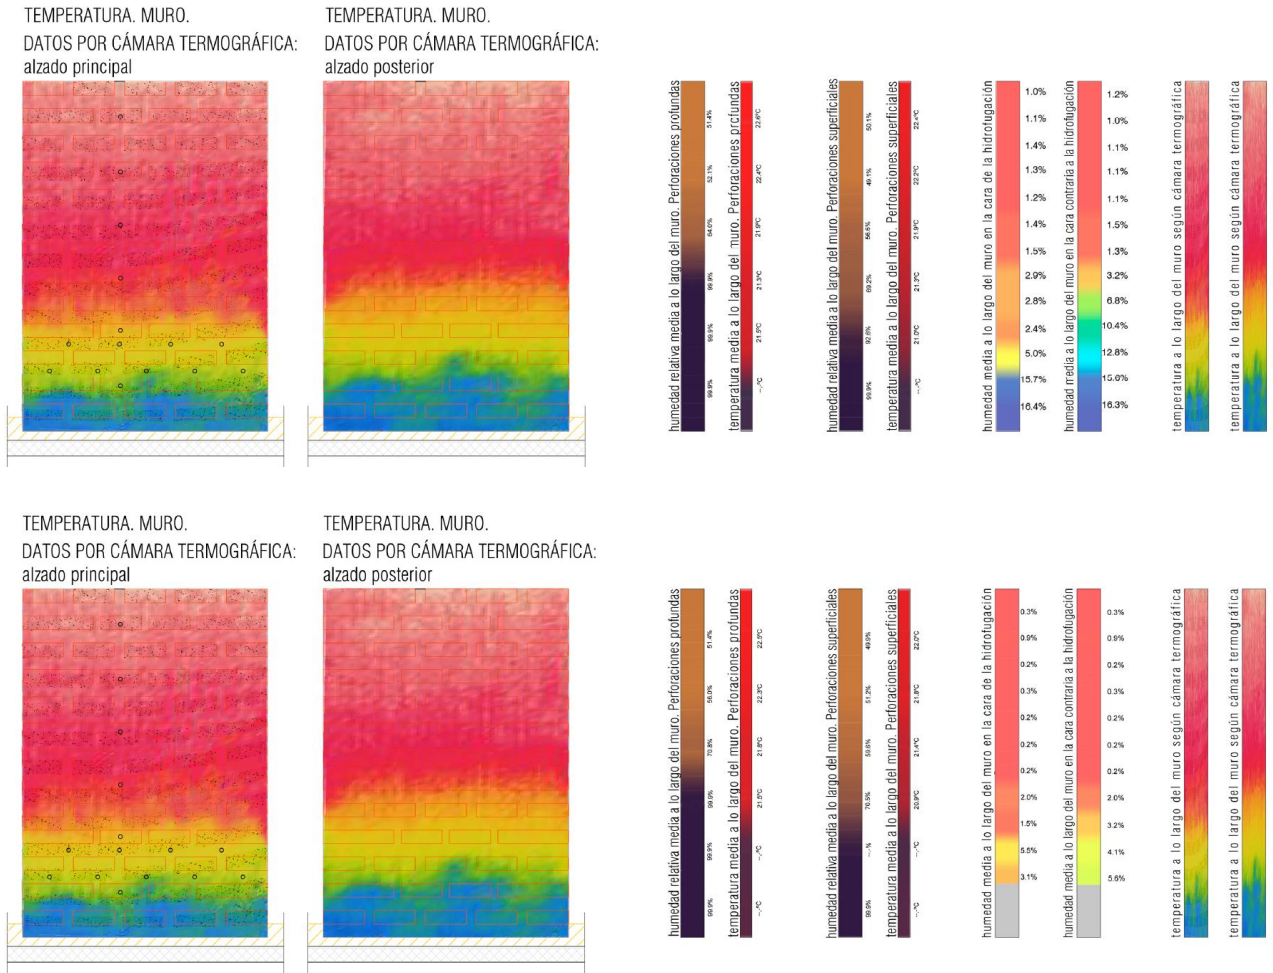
Alzados muro de 1 ½ asta de ladrillo moderno con barrera hidrófuga.
